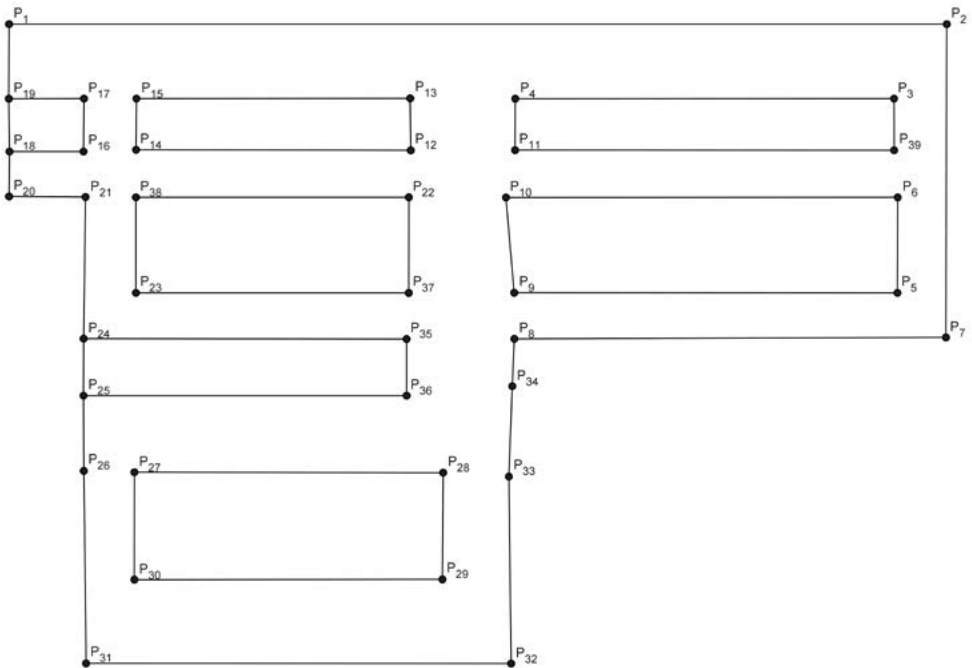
Eingemessene Kalibrierpunkte im Stallgrundriss (Koordinatensystem)
